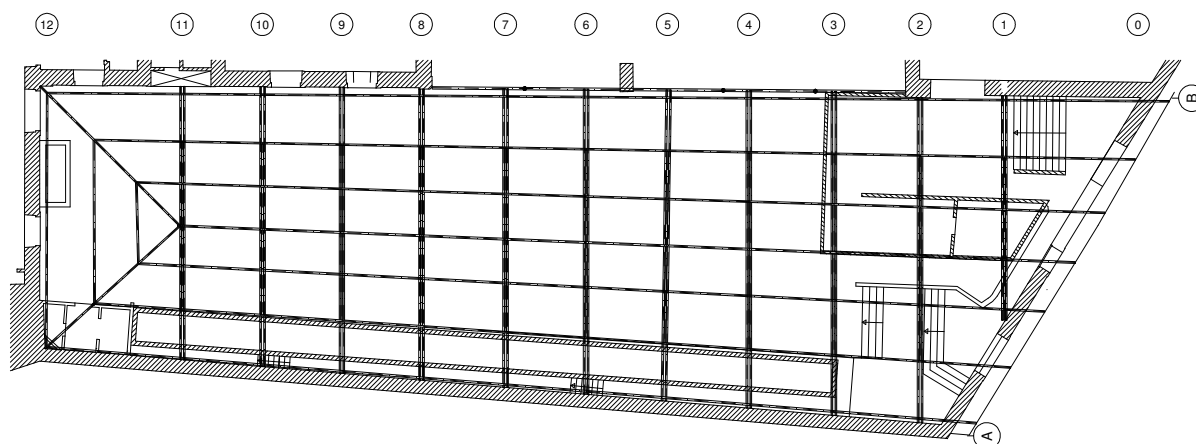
Planta estrutural da cobertura do armazém K (sem escala).
